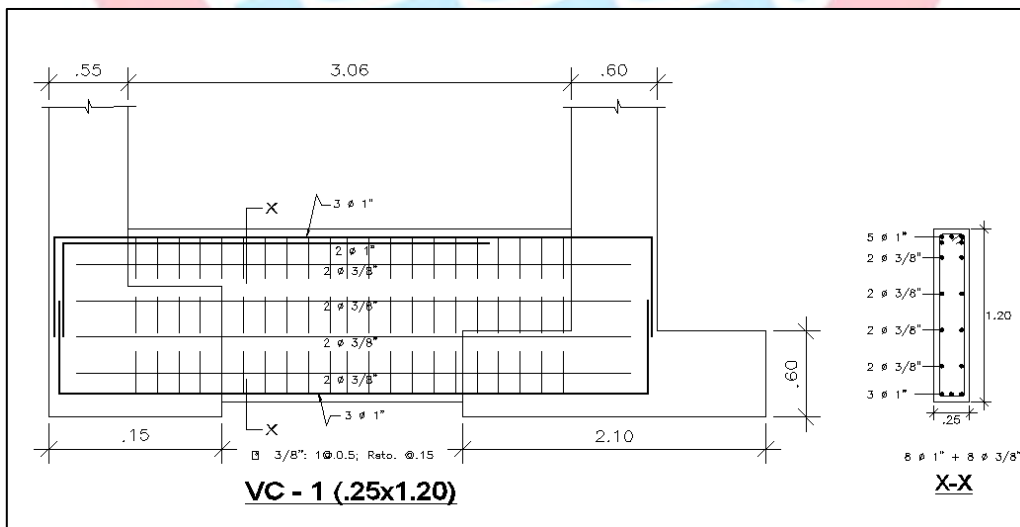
Diseño final de la viga de cimentación VC-01 (.30 x 1.20 m).
